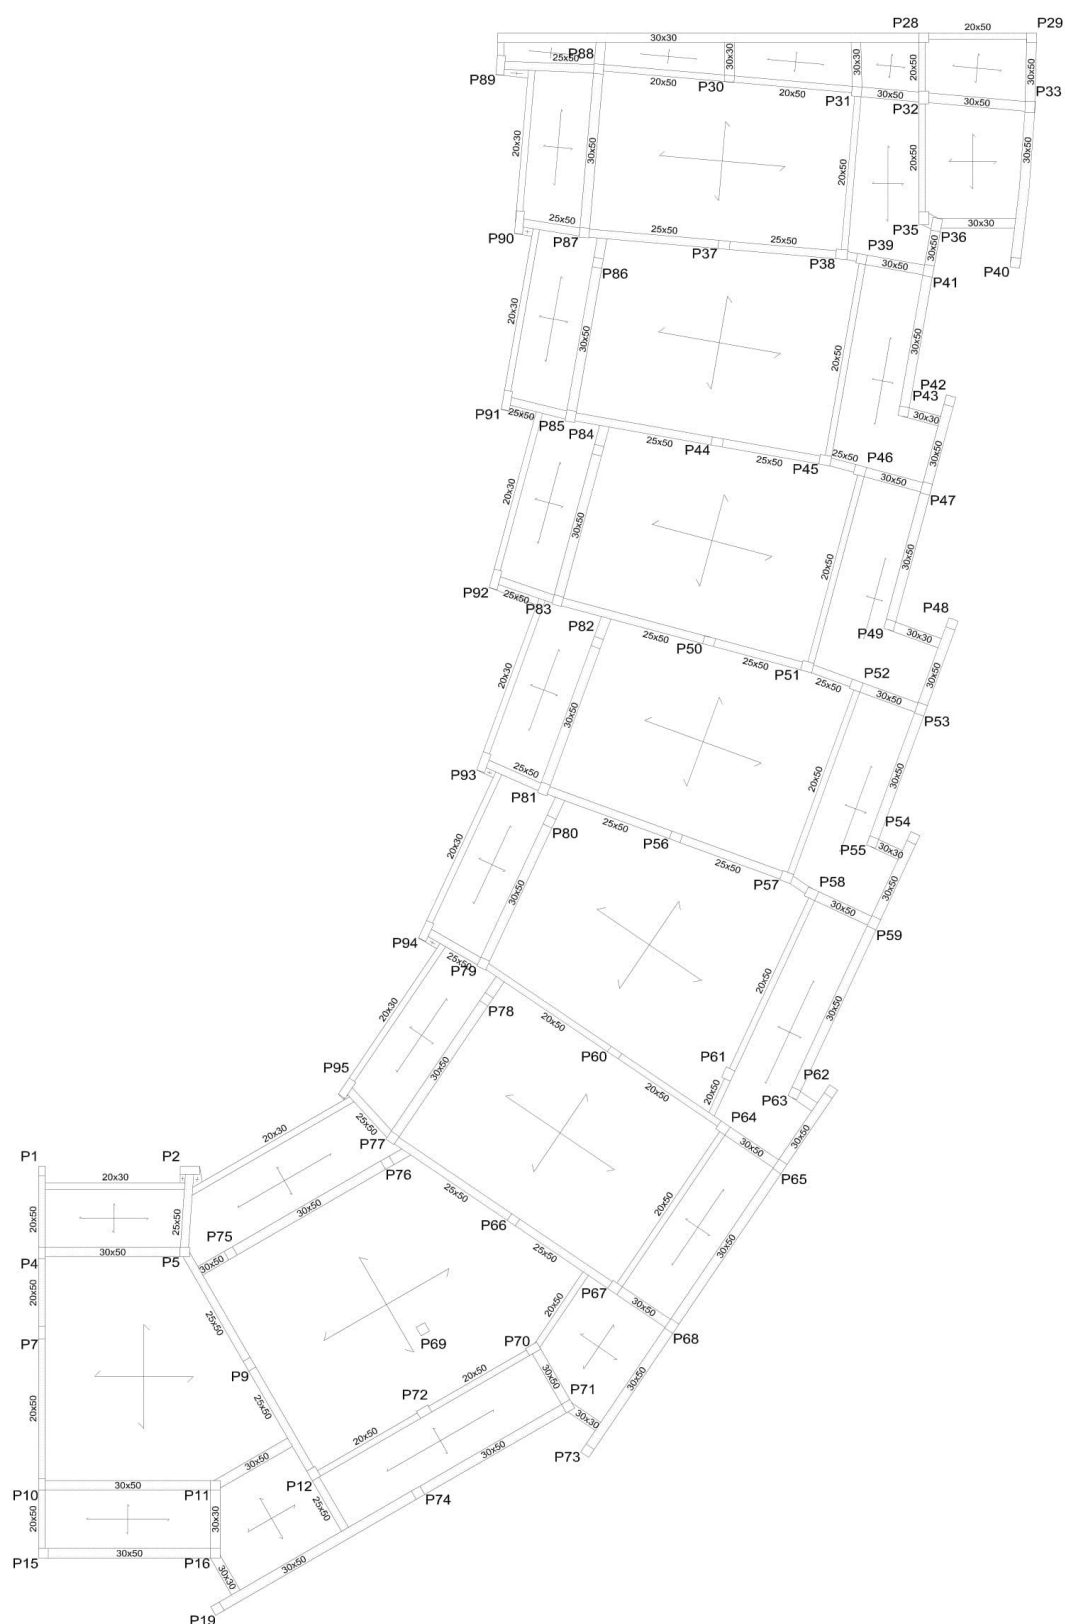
Planta estrutural do Piso 1: corpo F (s/escala).
